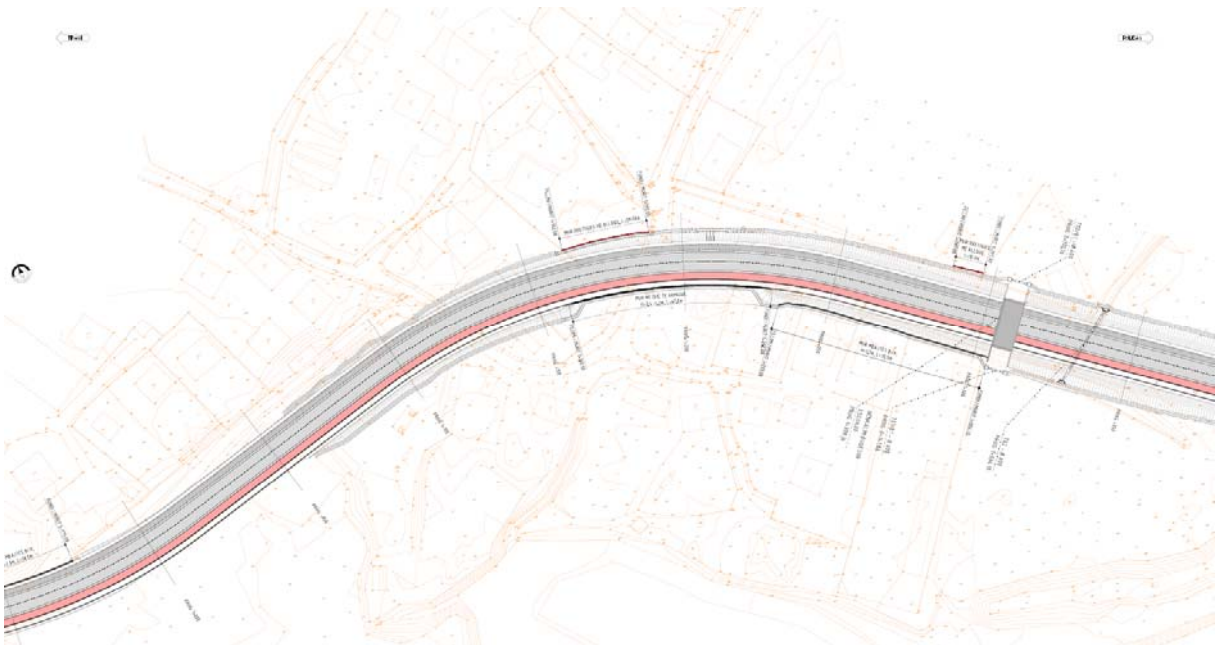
Pjesë nga planimetria e Rruges kryesore
